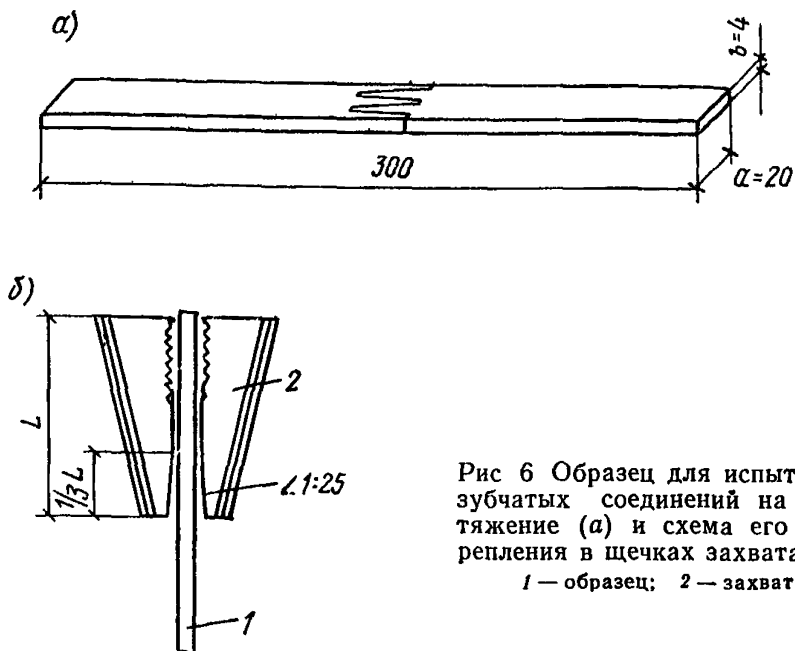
Образец для испытания зубчатых соединений на растяжение (а) и схема его закрепления в щечках захвата (б)
